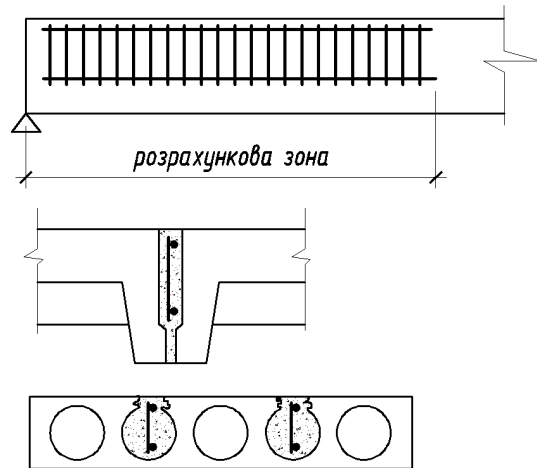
Підсилення плит каркасами по похилому перерізу:
